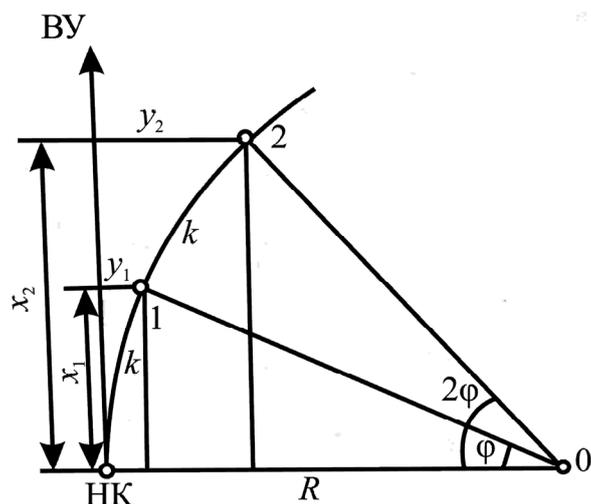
Схема детальной разбивки круговой кривой способом перпендикуляров
